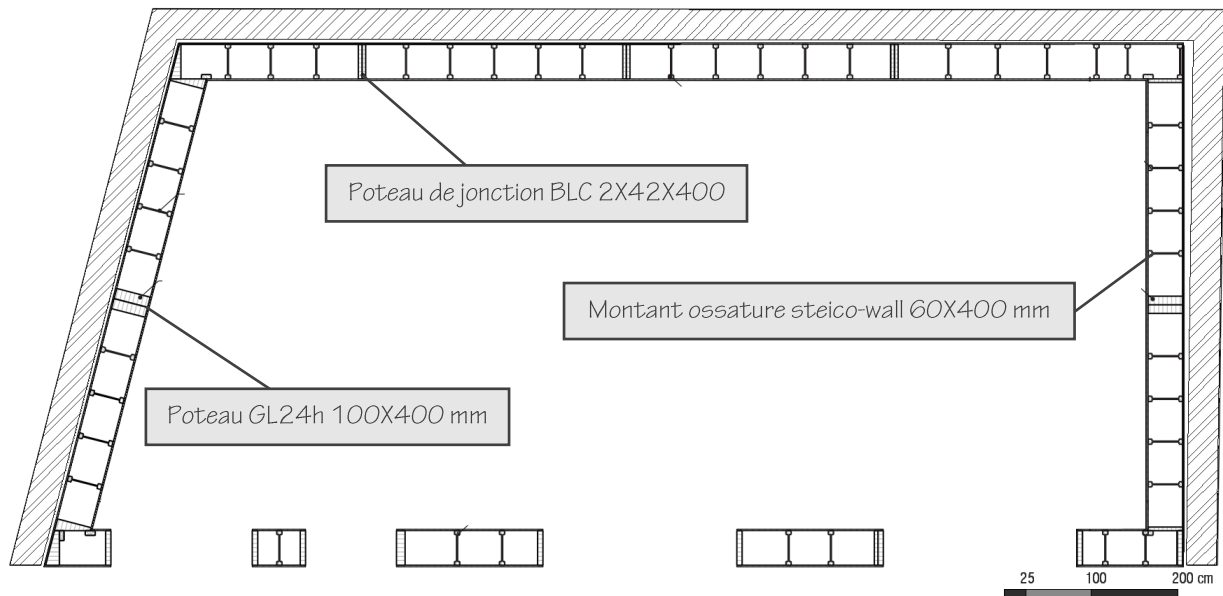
Plan détail de la structure du mur, 1<sup>er</sup> étage (Source : Bureau Modelmo, 2010)
